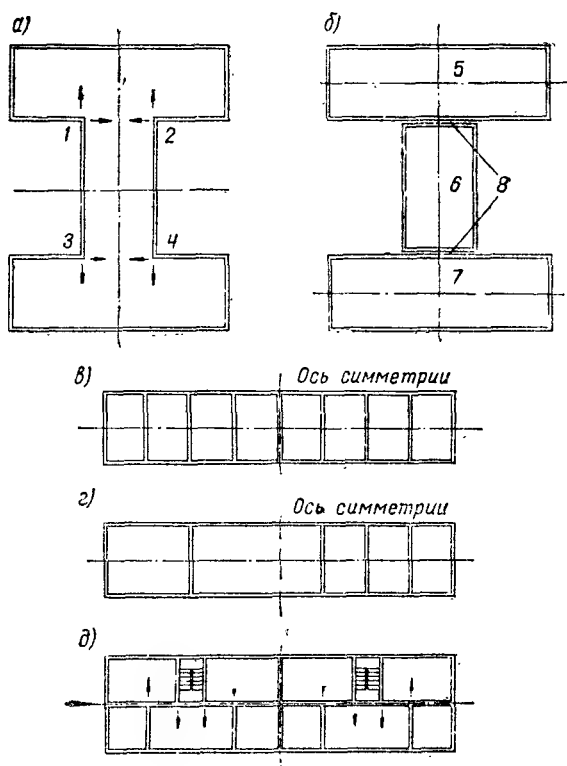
Схемы расположения несущих стен в зданиях, возводимых в сейсмических районах
